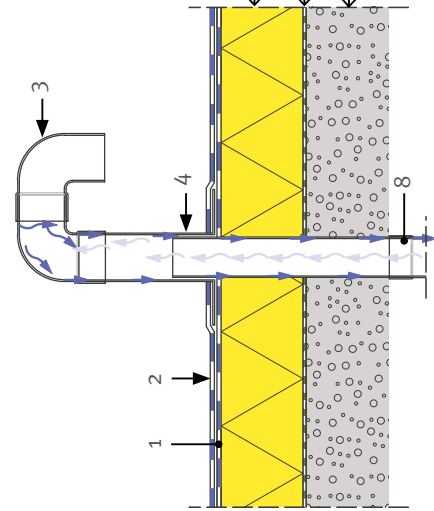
Condensation induite par la ventilation d'une conduite sanitaire.
